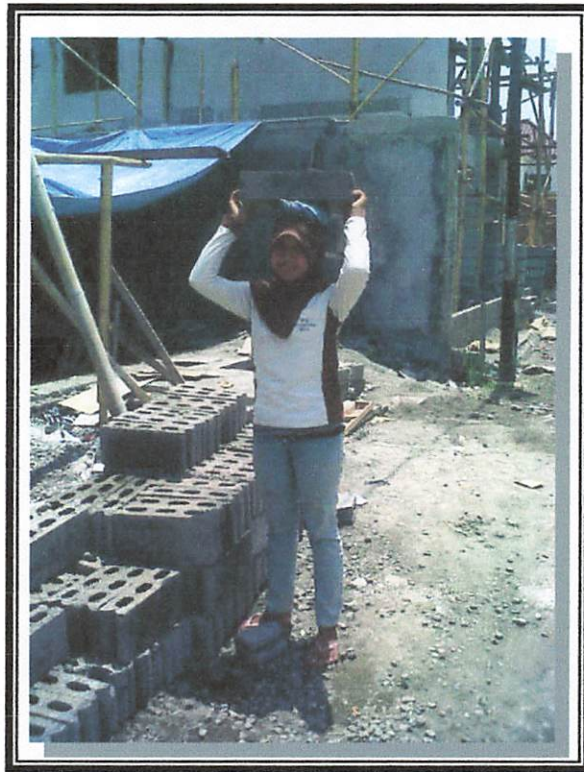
PEKERJA WANITA PASANGAN BATA/BATAKO
